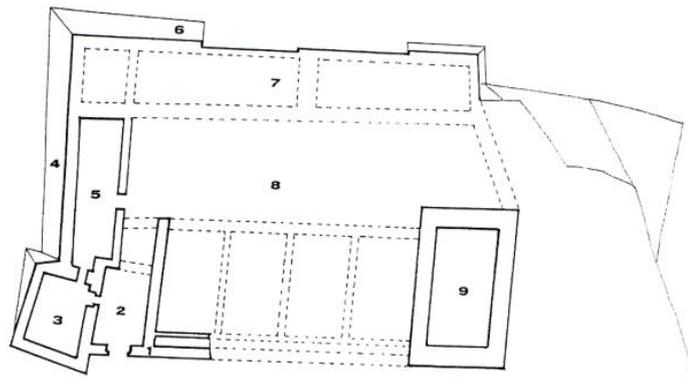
Calatafimi: castello Eufemio. Caratteristiche tipologiche e strutturali preesistenti. 1) Cortina muraria; 2) Vestibolo; 3) Torre quadrangolare sinistra; 4) Muraglione a scarpa del prospetto Sud; 5) Le celle; 6) Muraglione a scarpa del prospetto Ovest; 7) Le cisterne; 8) Cortile ed ambienti limitrofi; 9) Torre rettangolare destra.
